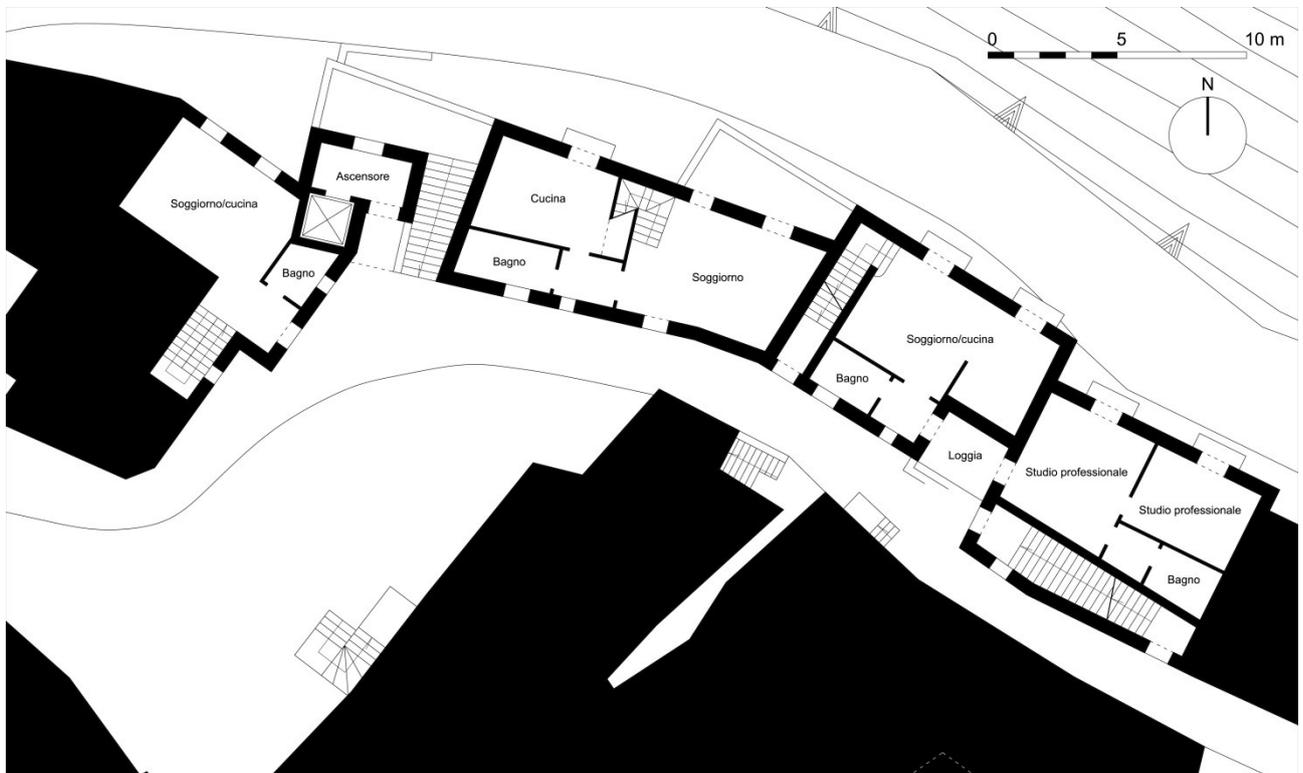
Pianta del piano terra (Via Sambuco)
